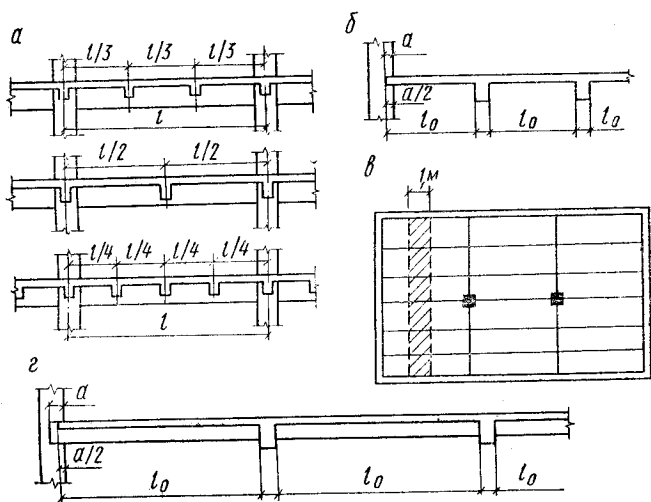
Схемы балок и плит ребристых перекрытий
